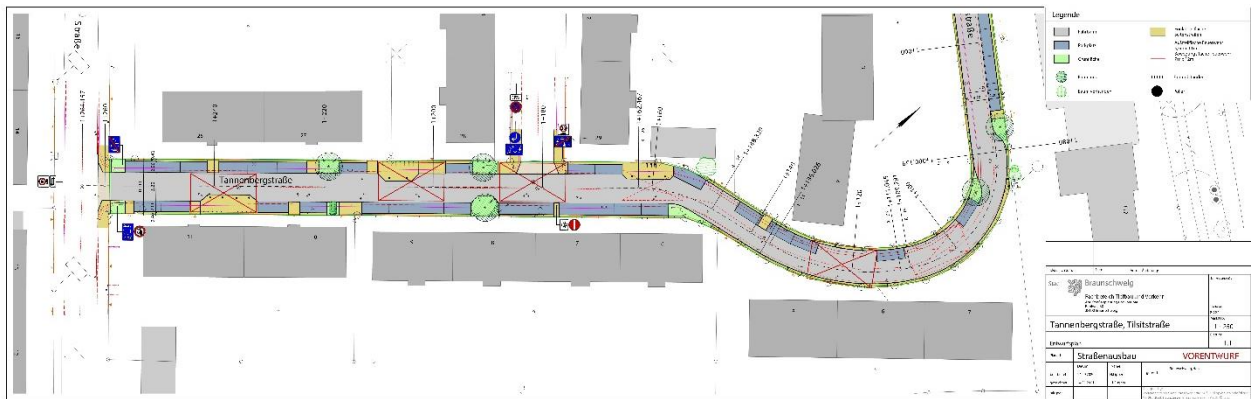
Geplanter Ausbau der Tannenbergsstraße (Quelle: Stadt Braunschweig, FB 66 2021)
